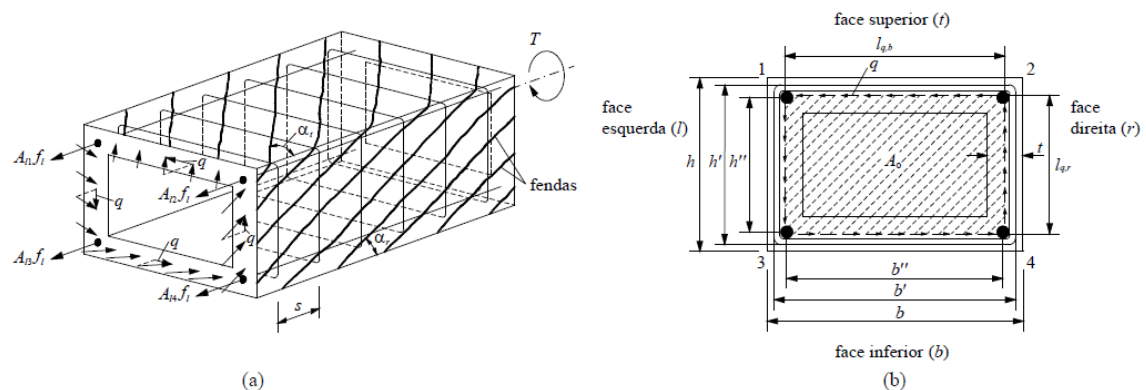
Viga com secção rectangular vazada sujeita à torção pura [9]
